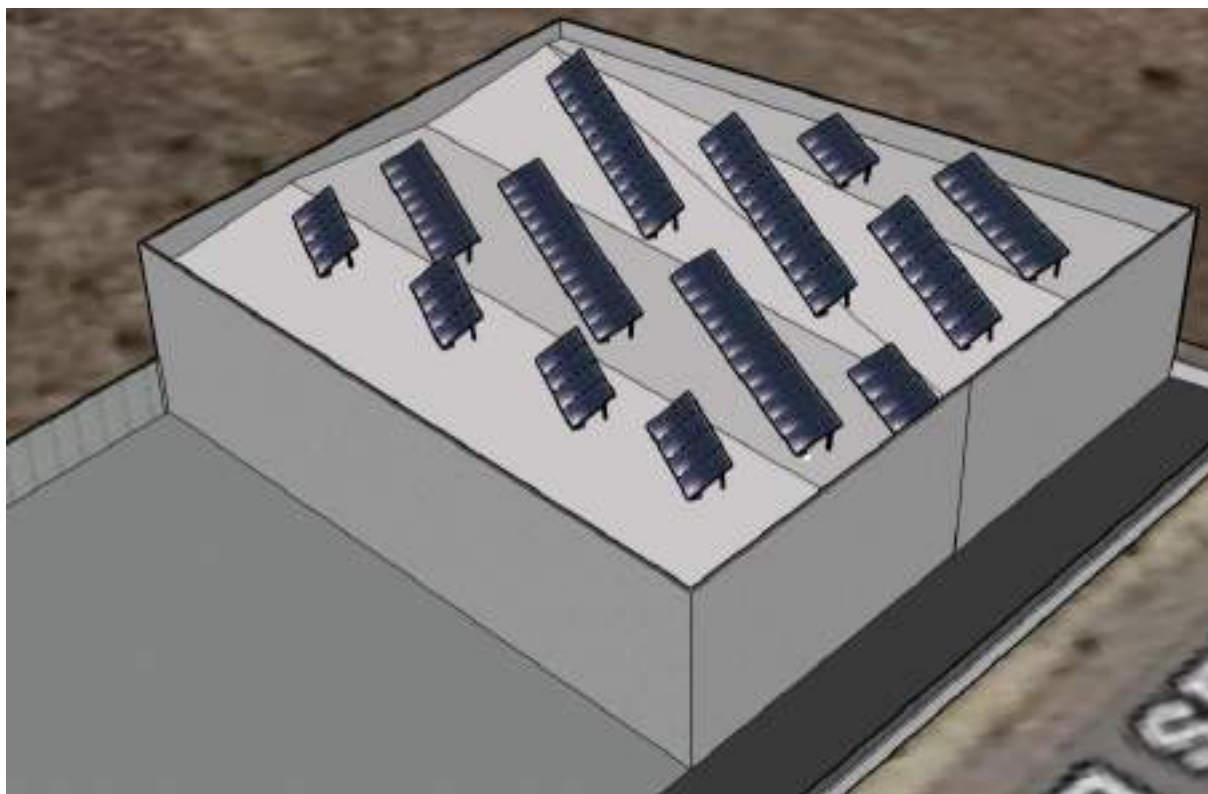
Vista en perspectiva del modelo 3D de la instalación sobre la cubierta
